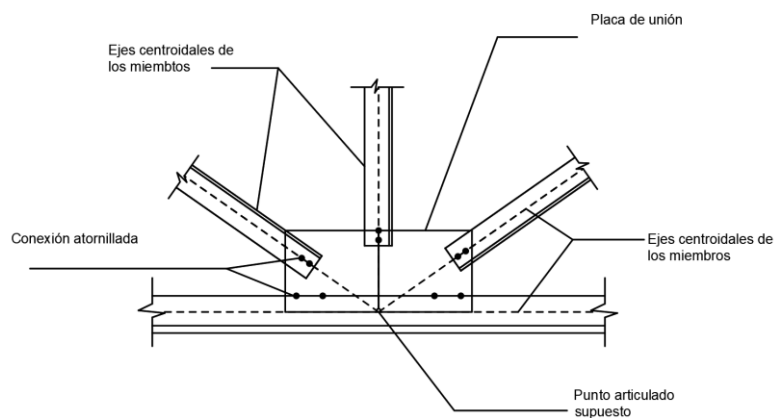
Análisis de fuerzas internas en miembros de armaduras
